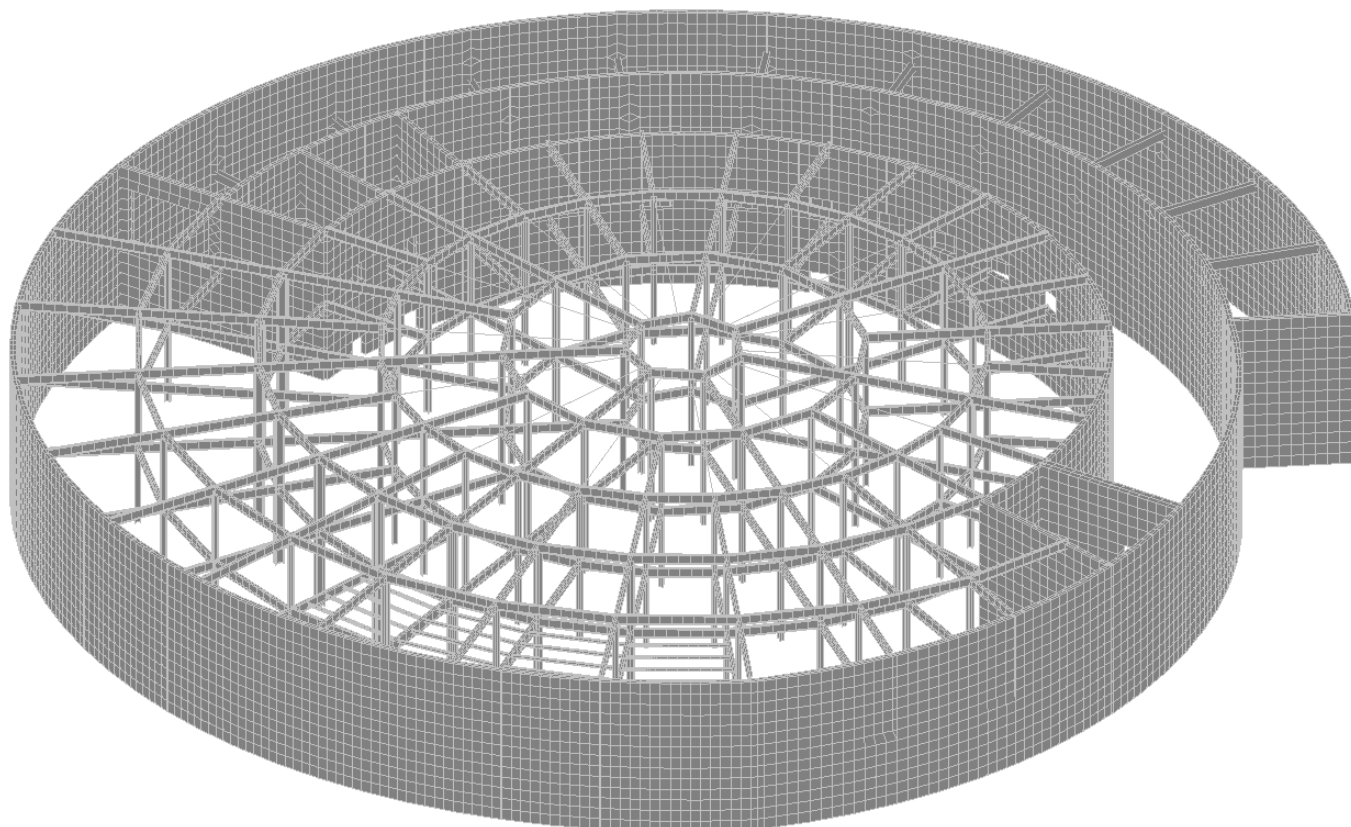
Расчетная схема здания без фундамента и перекрытий
